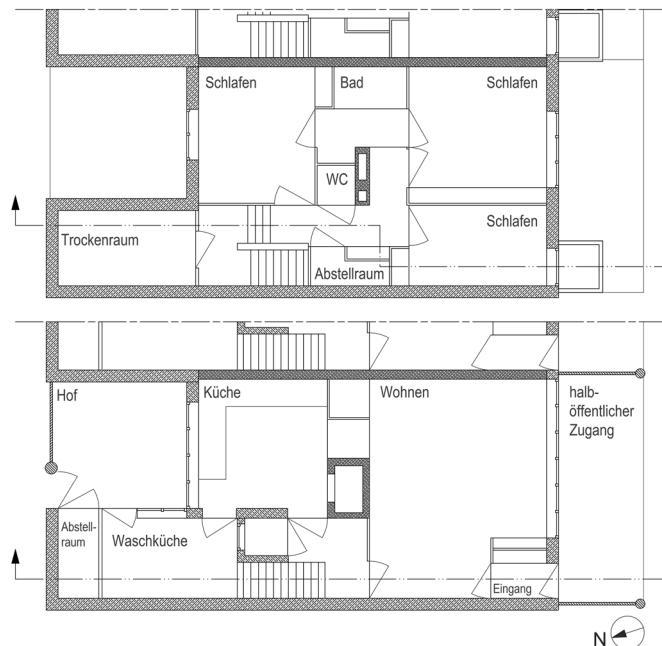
Schematischer Grundriss einer Reihenhauswohnung von Oud, oben: Obergeschoss, unten: Erdgeschoss, Stand 1927 nach [2]
